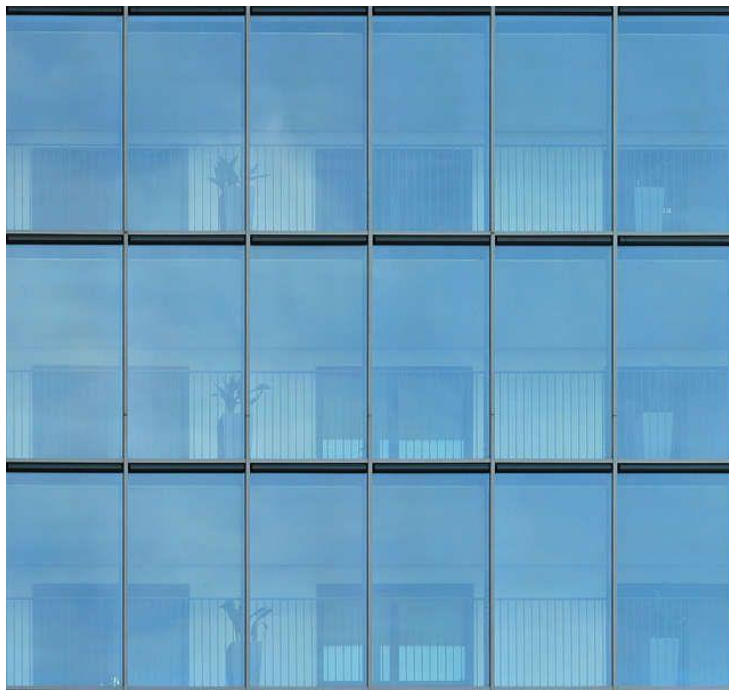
Ejemplo de Courting Wall. Fuente:
